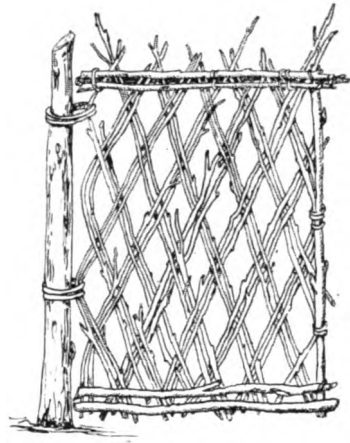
Tür einer Eingangshalle in Sutura. Höhe etwa 1,80 m.
